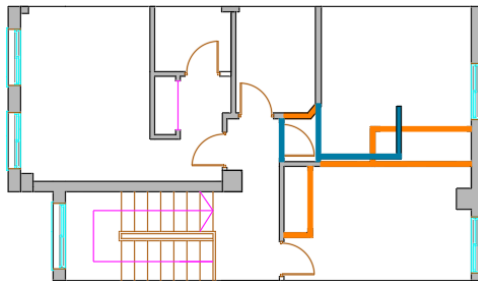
plano de demoliciones planta primera. Fuente propia
